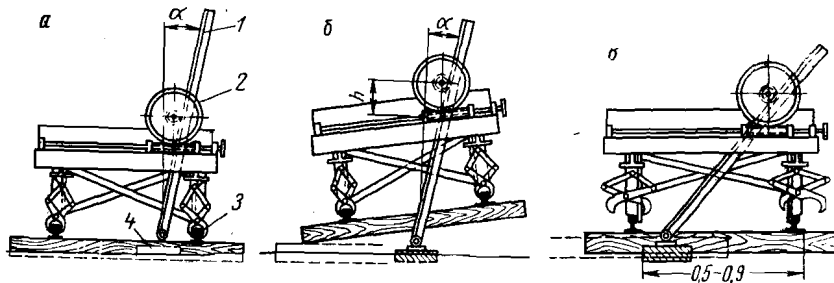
Схемы работы путепередвигателя циклического действия: а — исходное положение; б — подъем пути; в — конечное положение; 1 — зубчатая передача; 2 — подъемная шестерня; 3 — зажимы; 4 — упорный башмак
